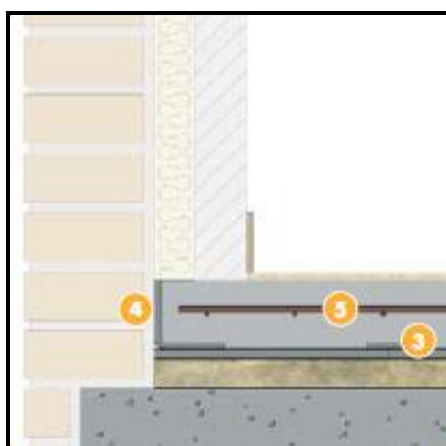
Encuentro pared-suelo. (3) Cinta de solape. (4) Desolidarizador perimetral. (5) Lámina armada con cargas minerales.
